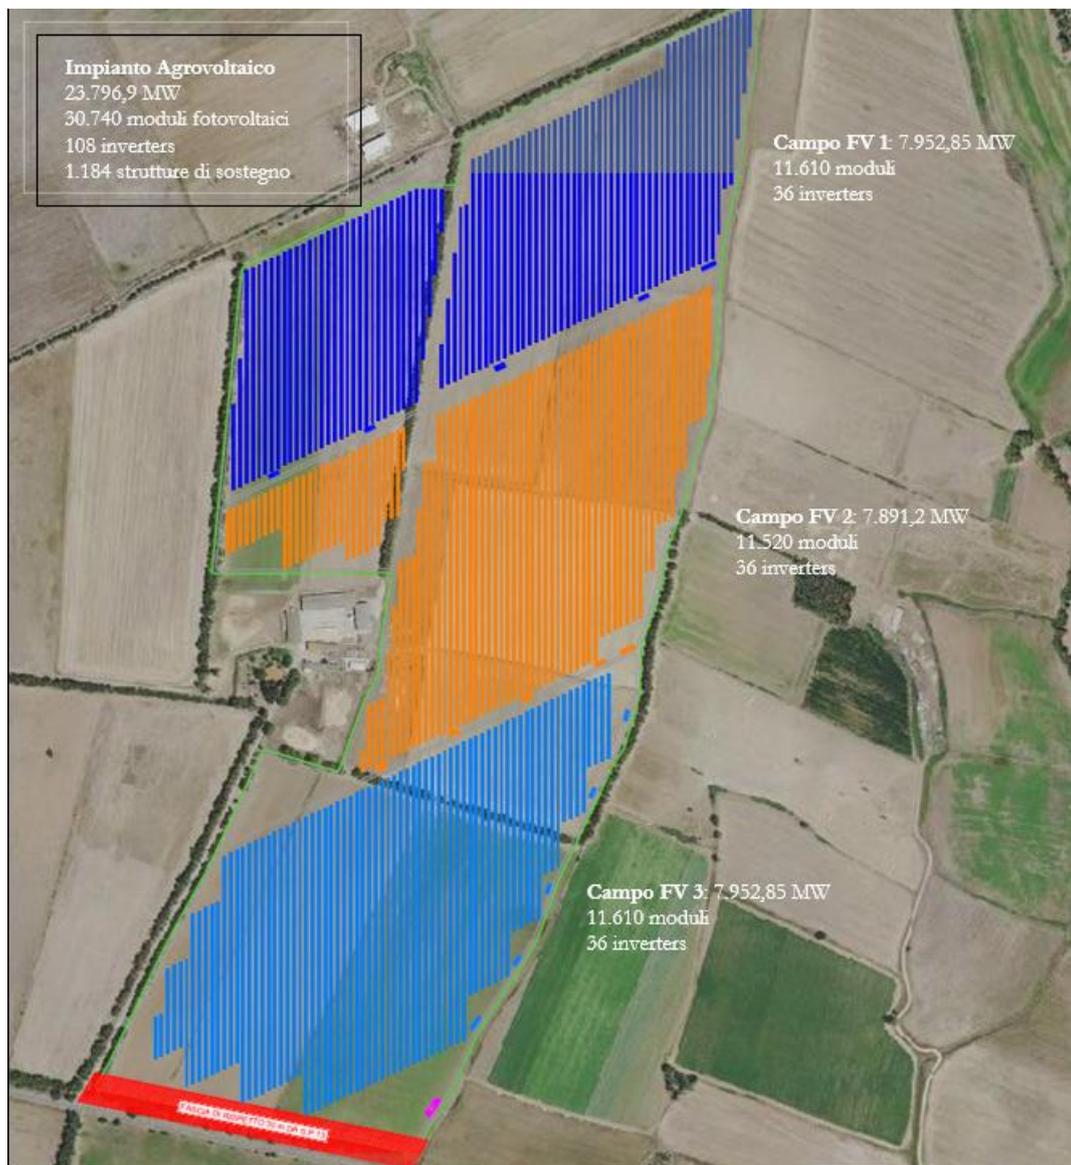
Layout d'Impianto Agrovoltaiico San Vero Milis - ortofoto
